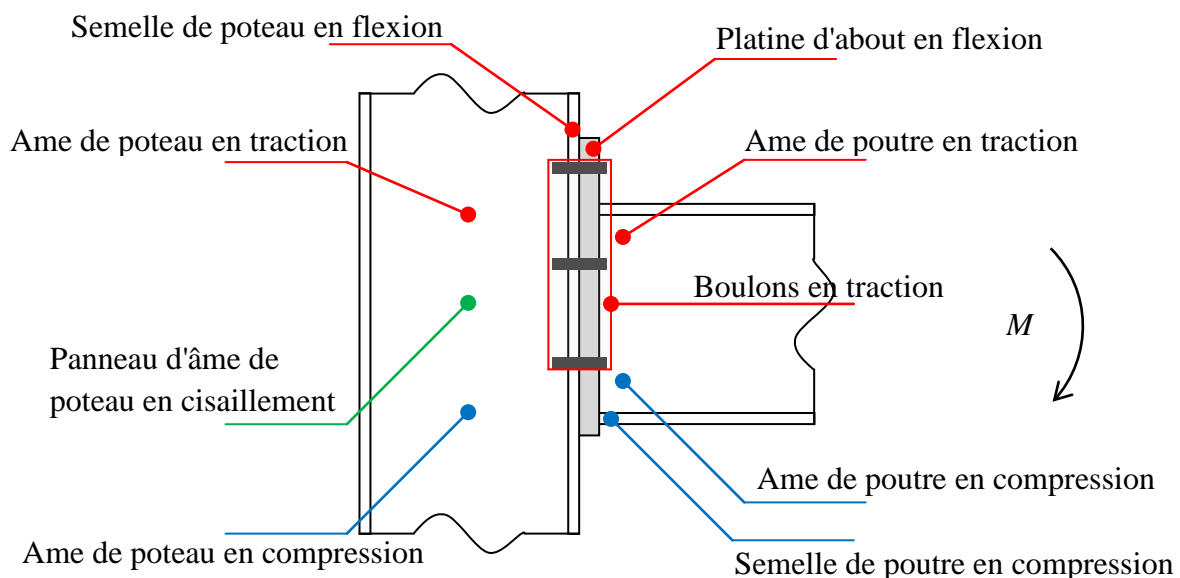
Composantes de base d'un assemblage boulonné par platine d'about.
